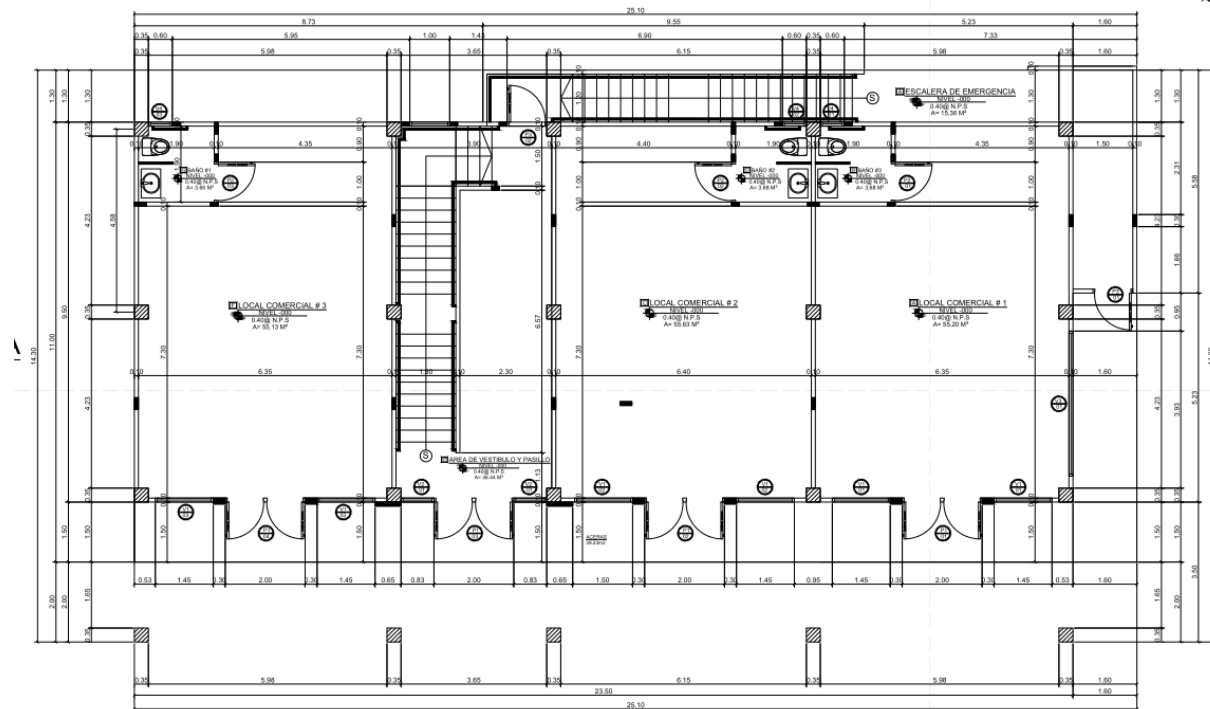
PLANTA ARQUITECTÓNICA – NIVEL 00
